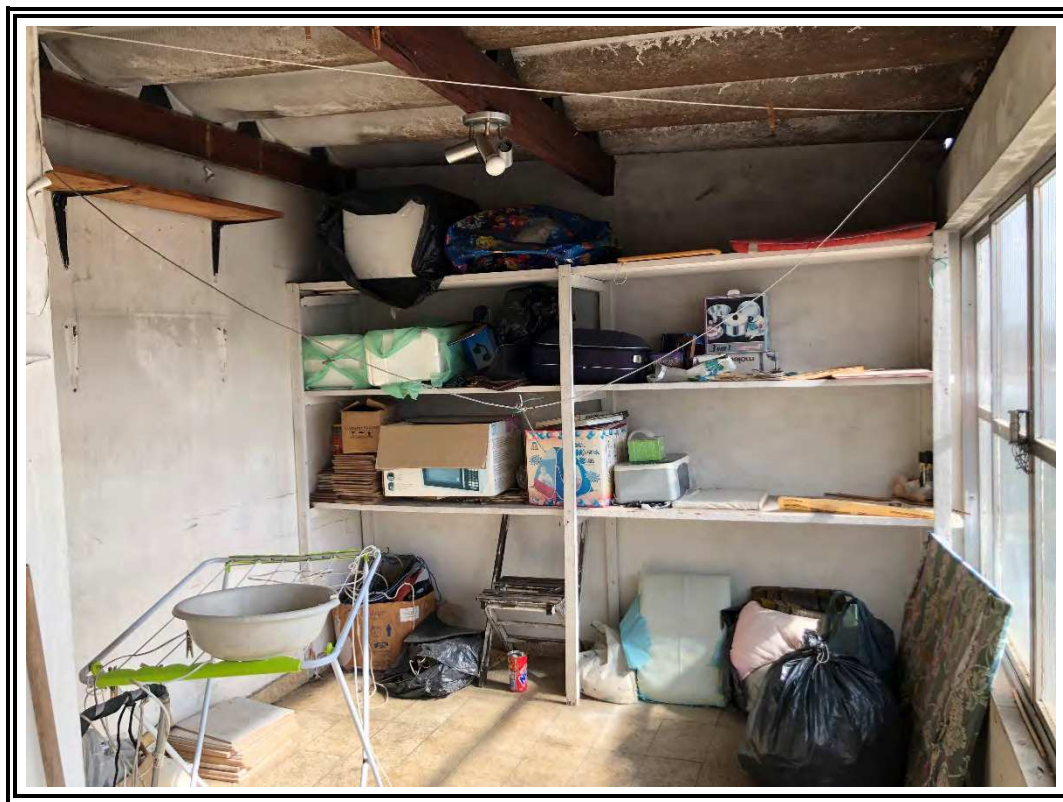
e 24: Vista da parede do dormitório 2 com detalhe do acabamento deteriorado devido a infiltrações
